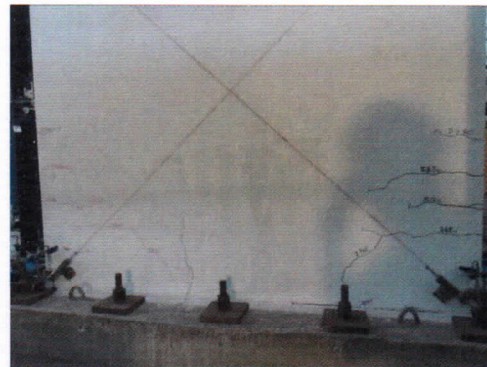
Nuevas grietas horizontales a la altura de las columnas para una distorsión 1/2150 Vista cara Norte.
